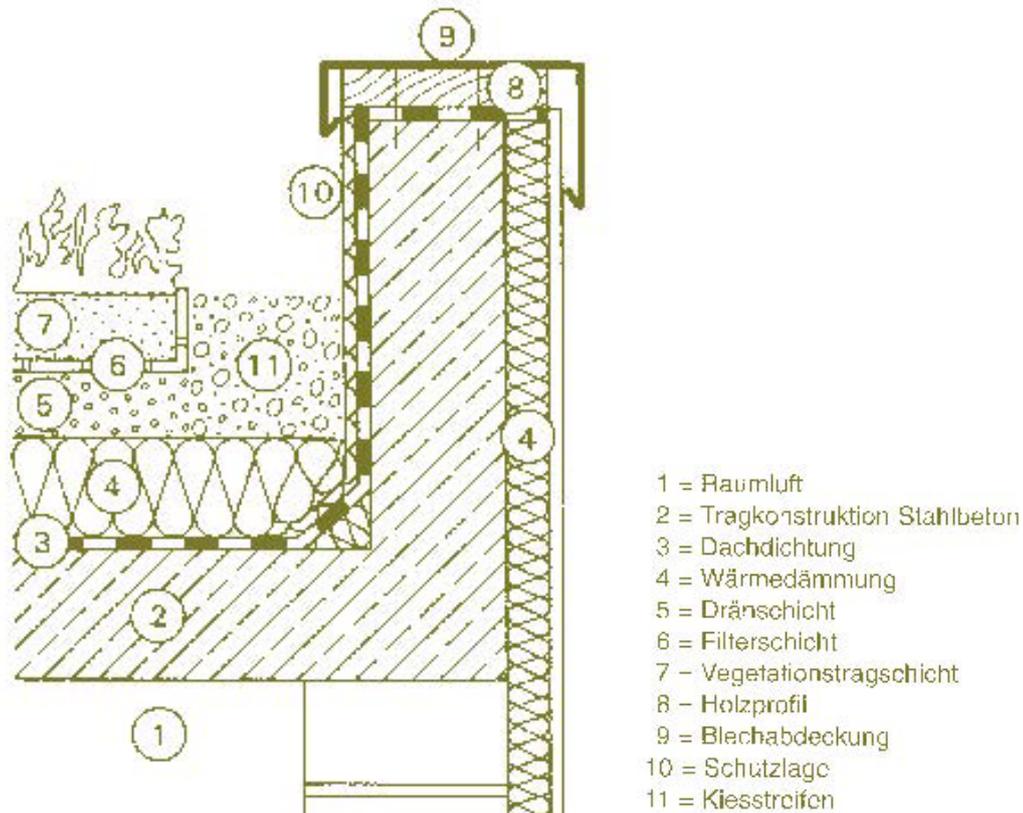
Konstruktiver Aufbau Umkehrdach
